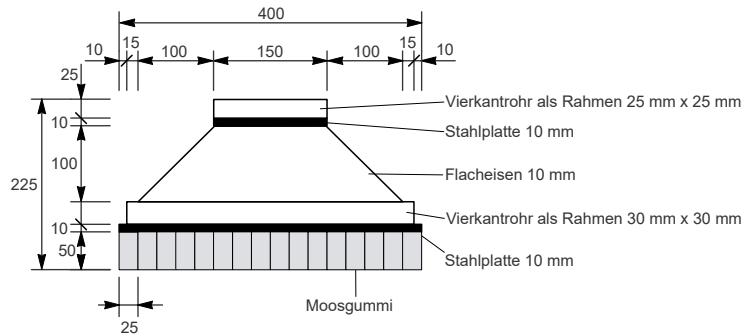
Modellversuchsstand zum Grundbruch Detailansicht Fundament
